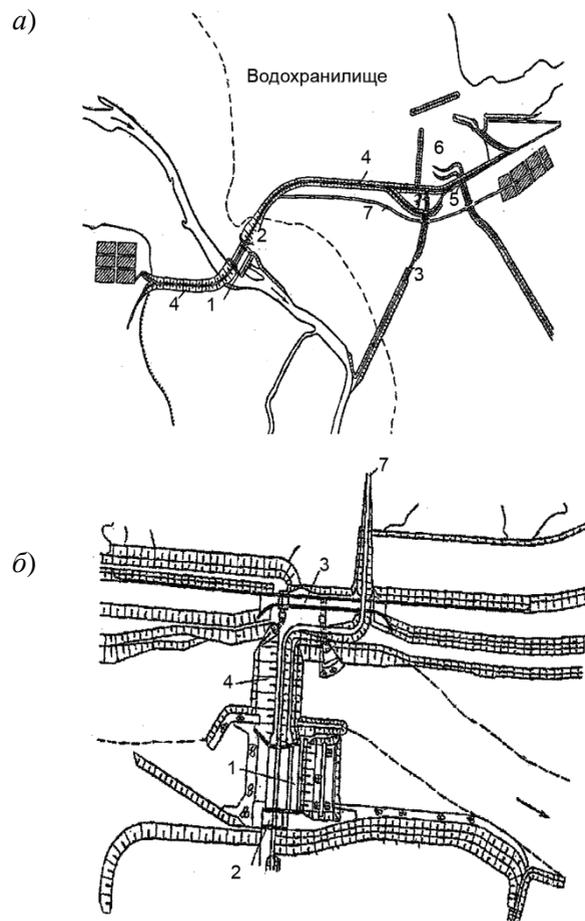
Схема планового очертания напорного фронта гидроузлов:
